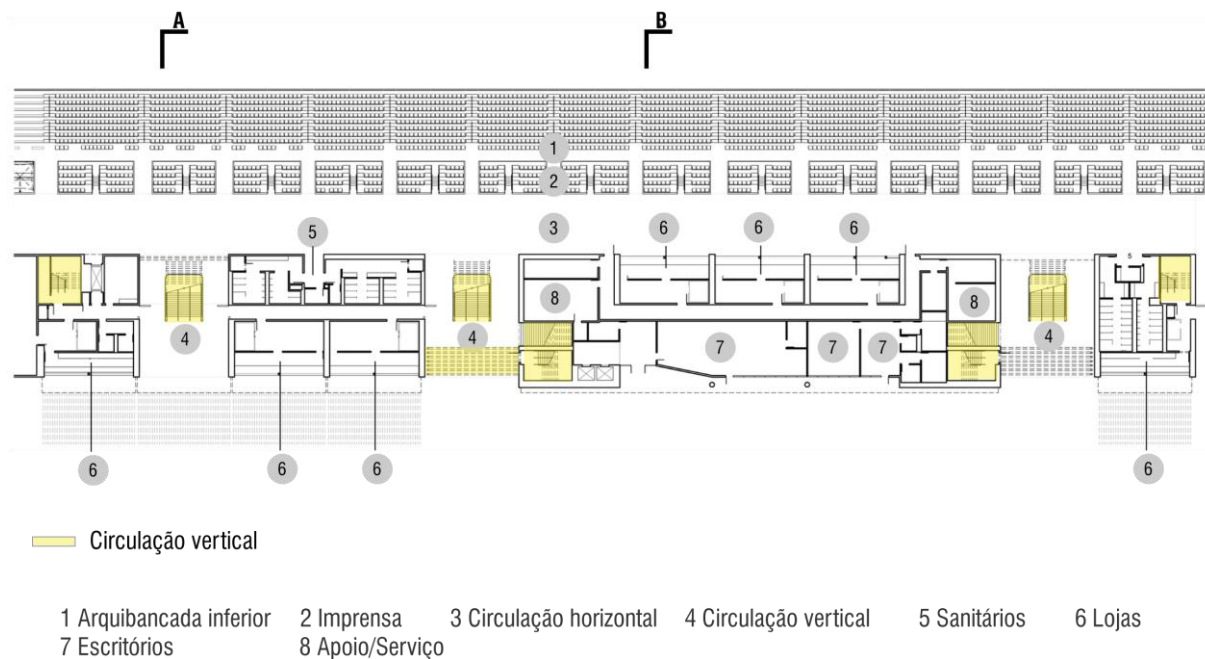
Planta baixa Arquibancada Principal - Nível 01
